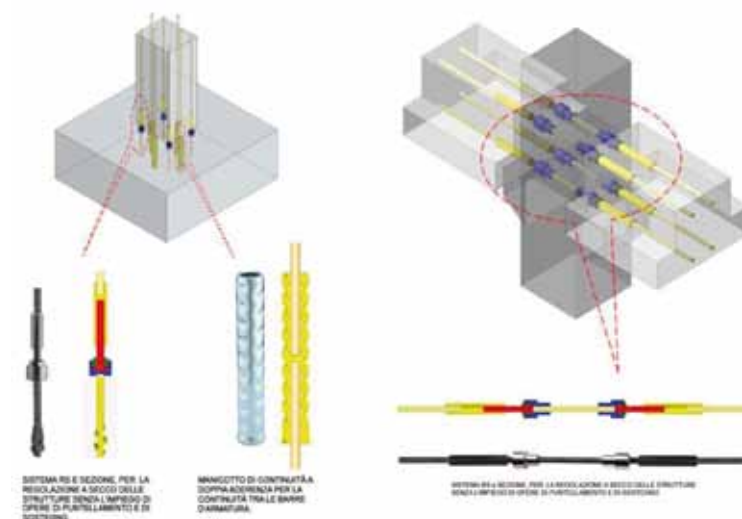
Esempificazione di un collegamento colonna fondazione e di un nodo trave colonna.
